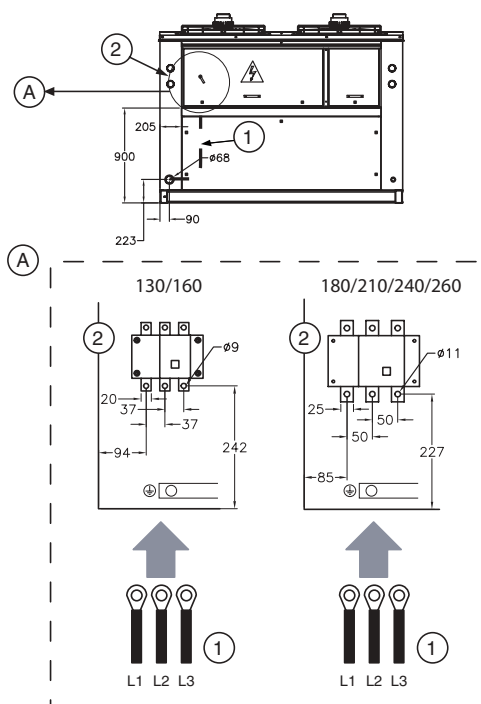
collegamenti elettrici EWAP/EWYP 130-260
